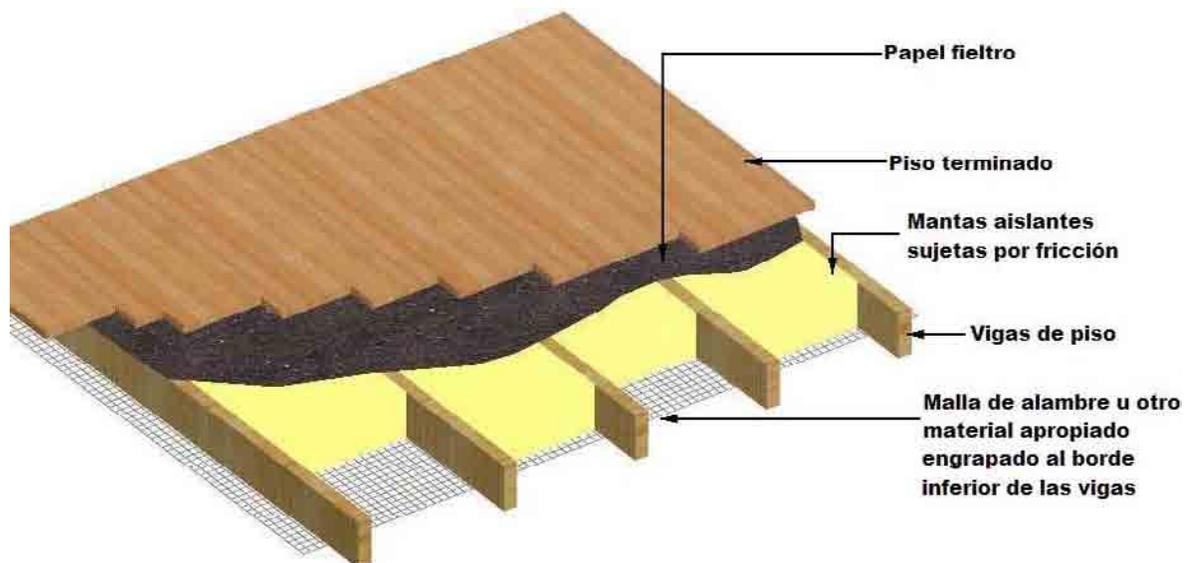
Detalle constructivo para el aislamiento del piso. Fuente: Elaboración propia.
